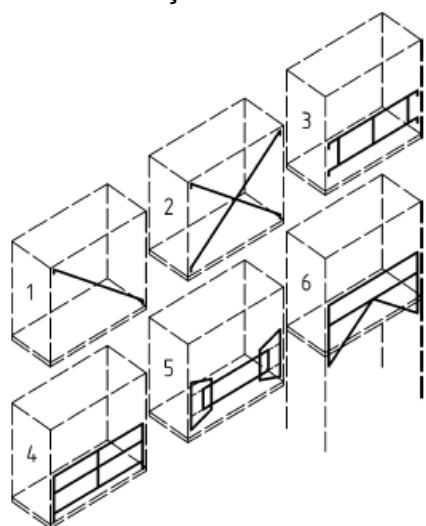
Exemplos de planos verticais rígidos usando contraventamento
